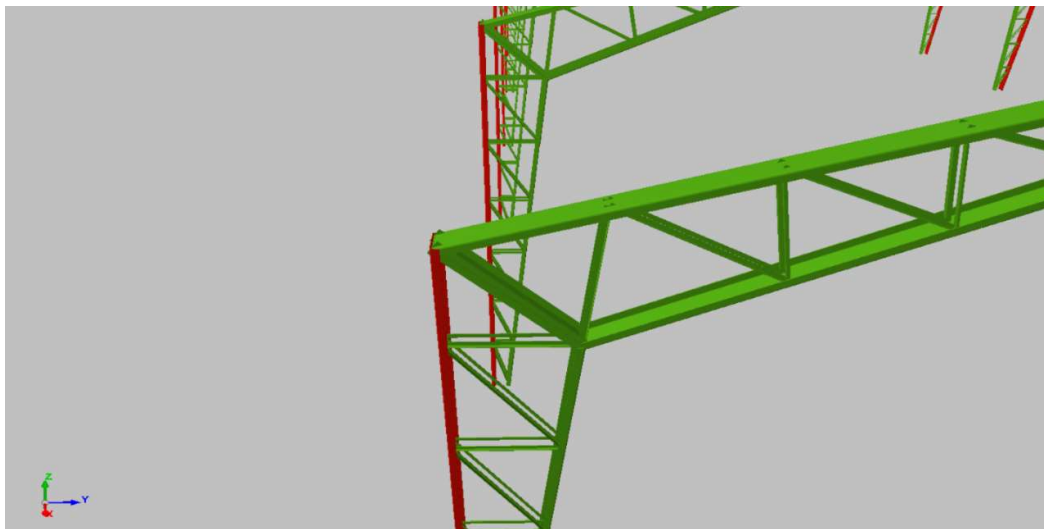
Vista 3D del elemento especial izquierdo en doble unión en "T"
